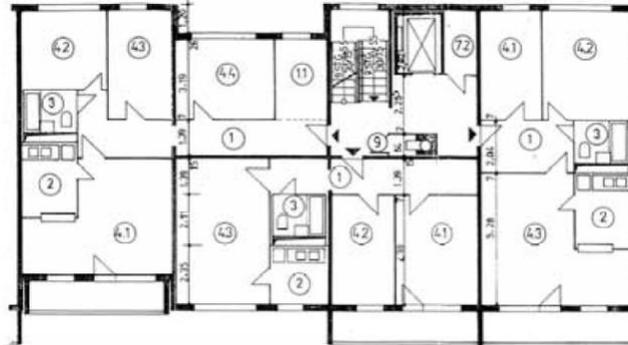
Typischer Grundriss des Plattenbau-Typs WBS 70 [2].
